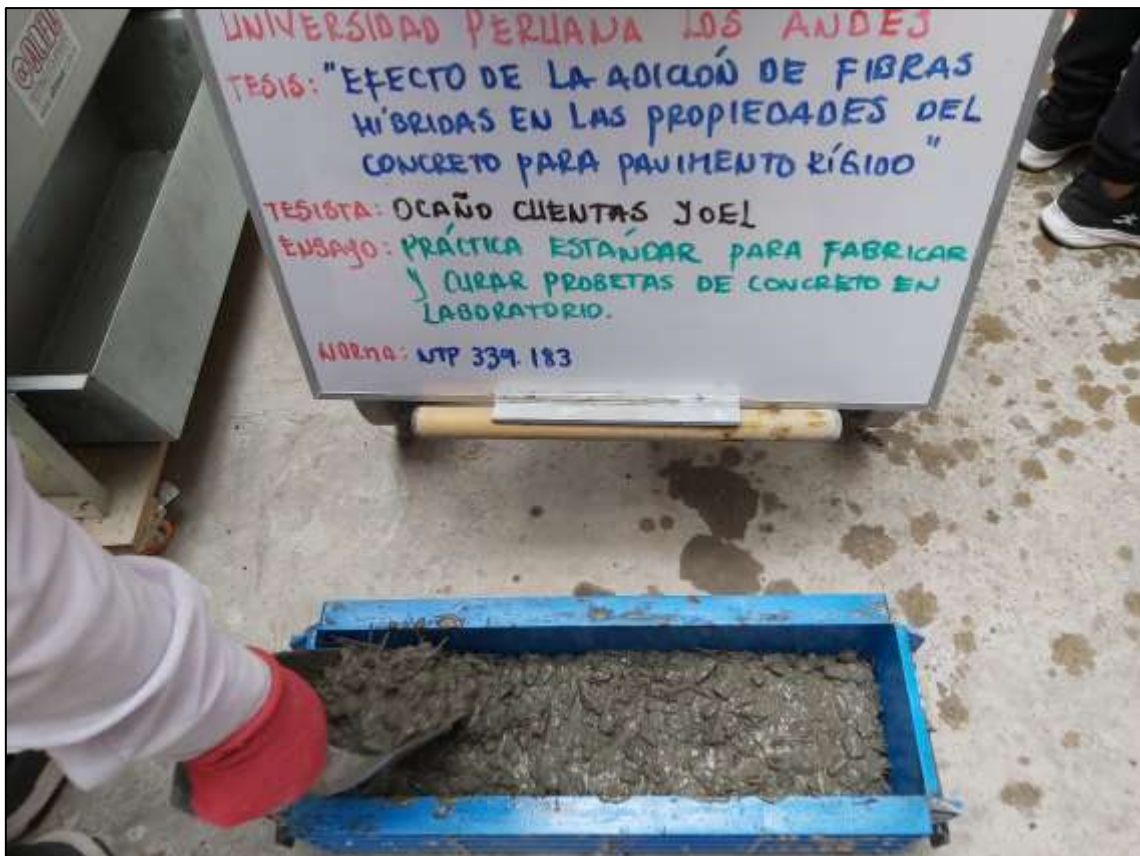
Muestreo de vigas de concreto con adición de fibras híbridas en laboratorio.
